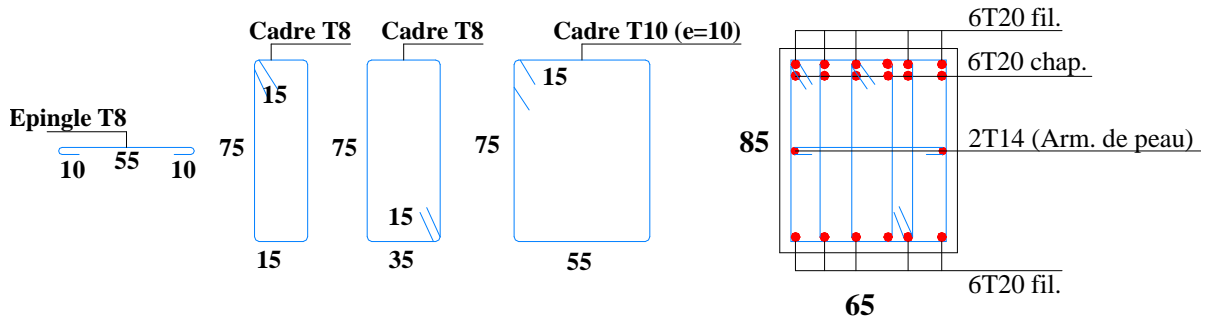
détails de ferrailage d'une travée de nervure.
